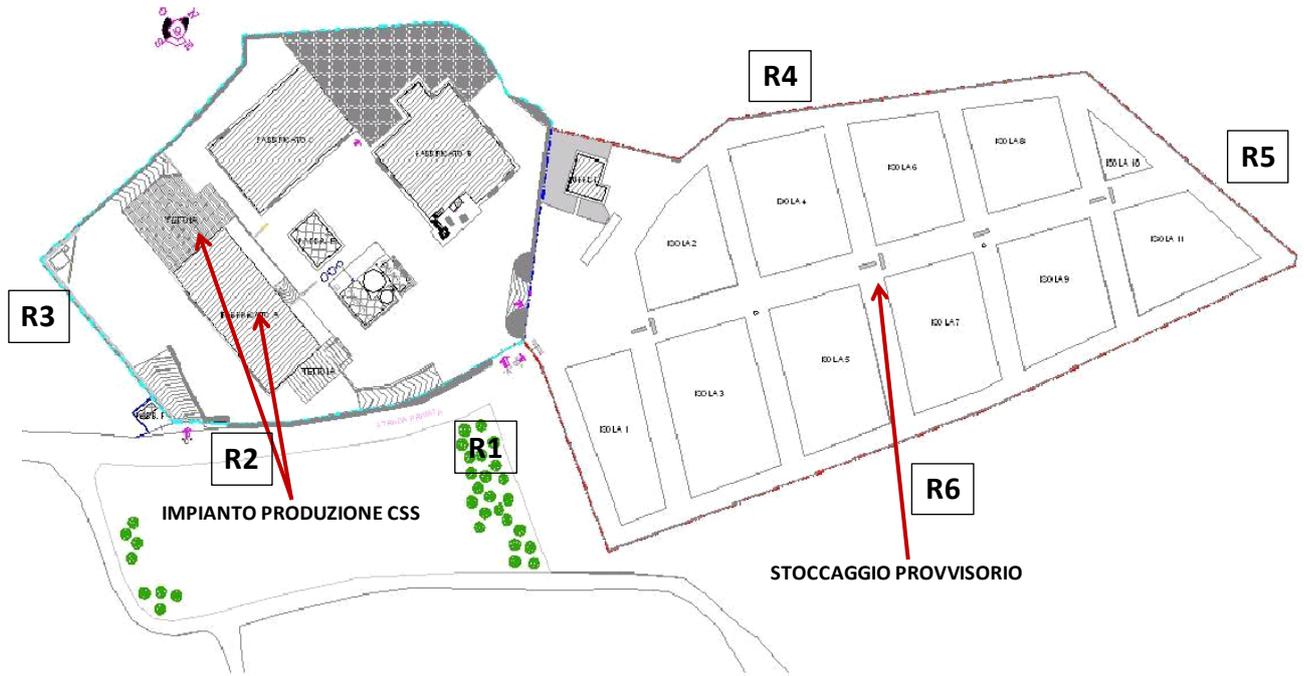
Planimetria con indicazione dei punti di monitoraggio dell'emissione acustica (Rn) al perimetro dell'intera installazione.
